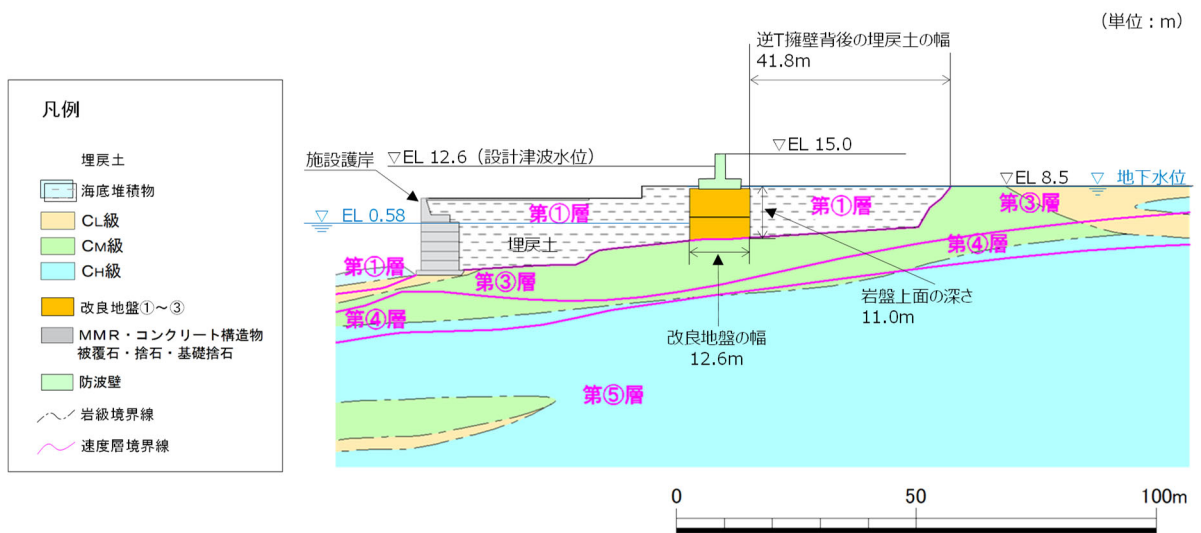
防波壁（逆 T 擁壁）の横断面図（⑥-⑥断面）
